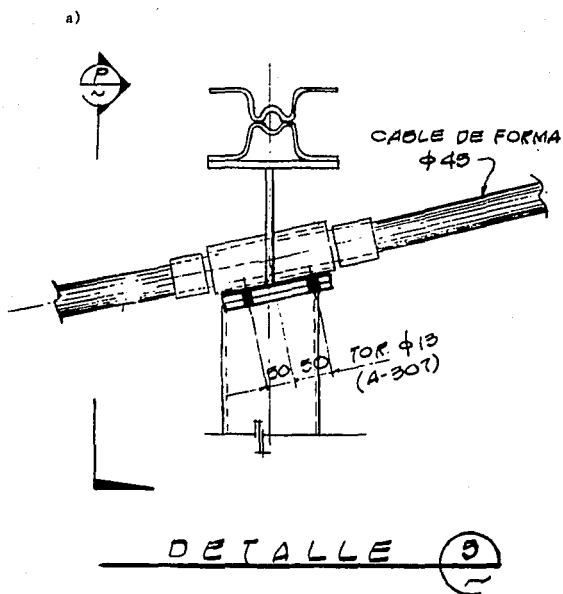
Conexión cable de forma-puntal-joist en la parte central de la armadura.
